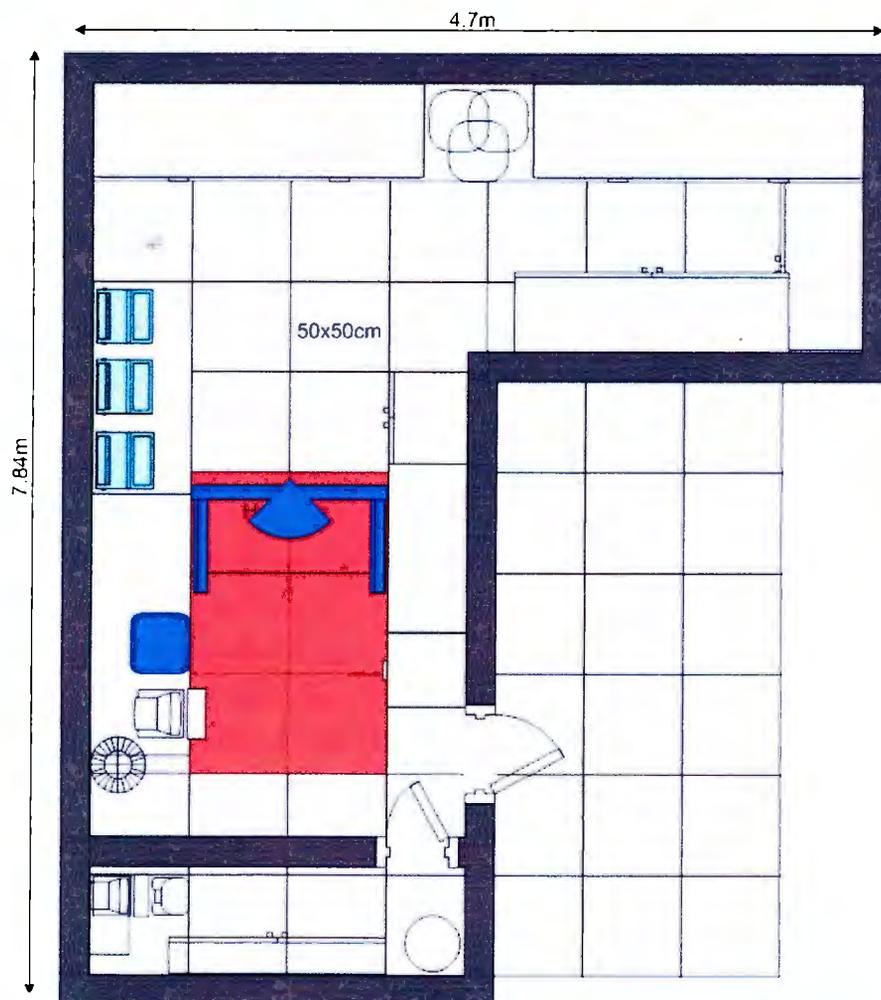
Layout de restaurante a potencia de 32.5 dBm
